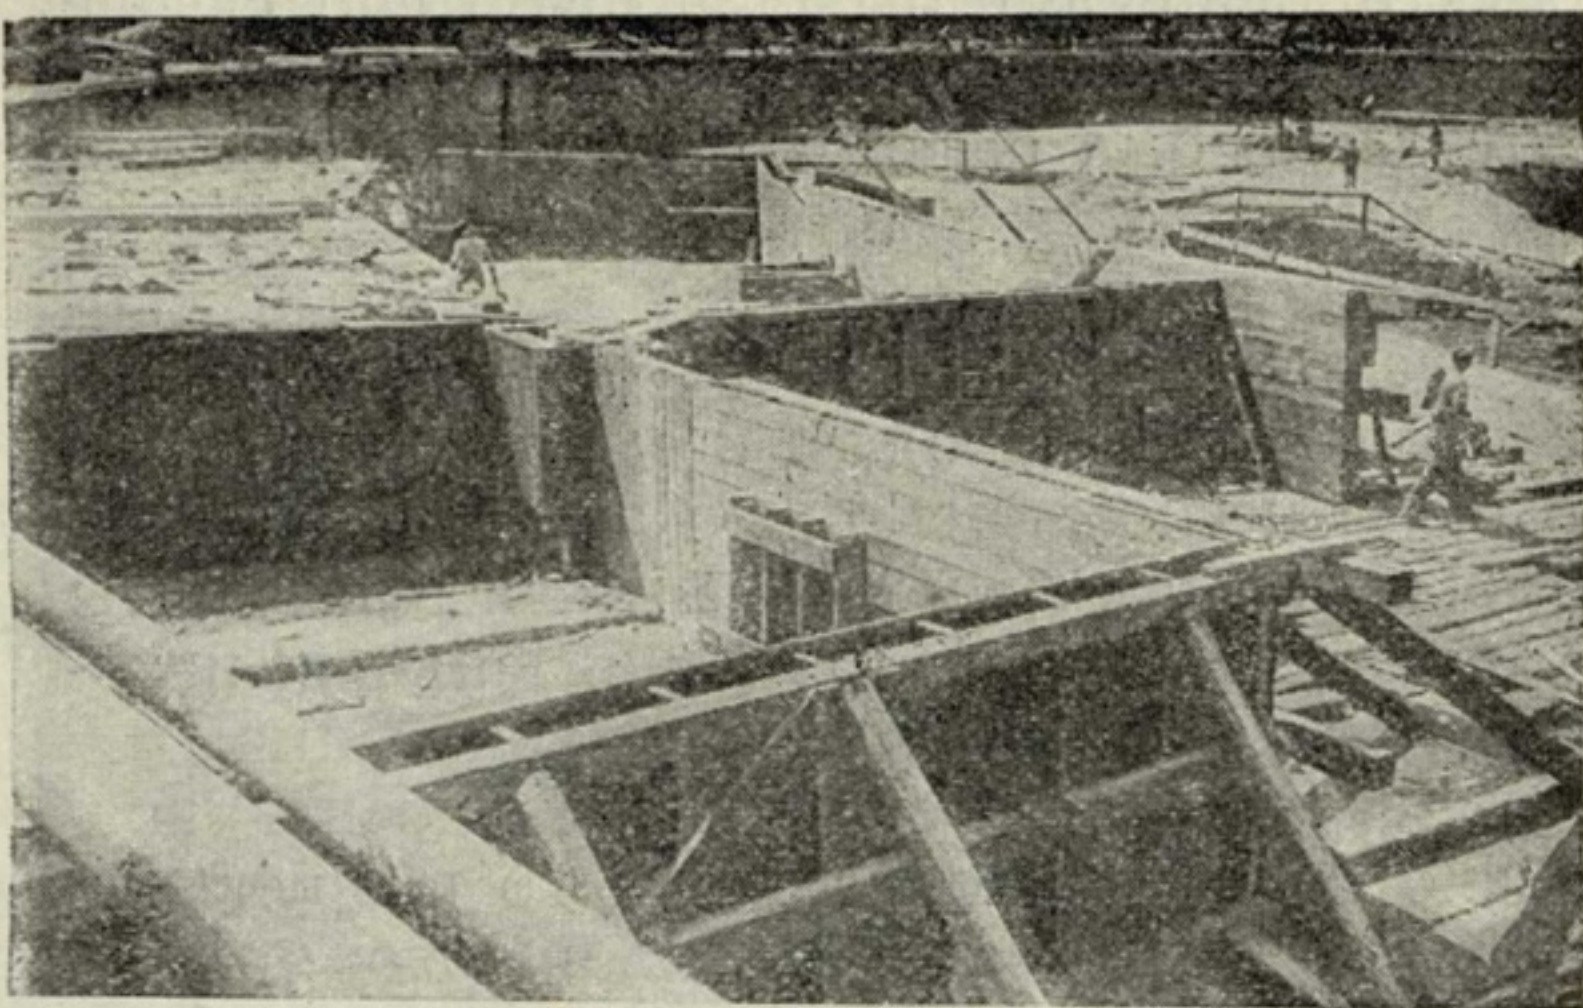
Щитовая опалубка, установленная для кладки блоков массивных бетонных полов.
